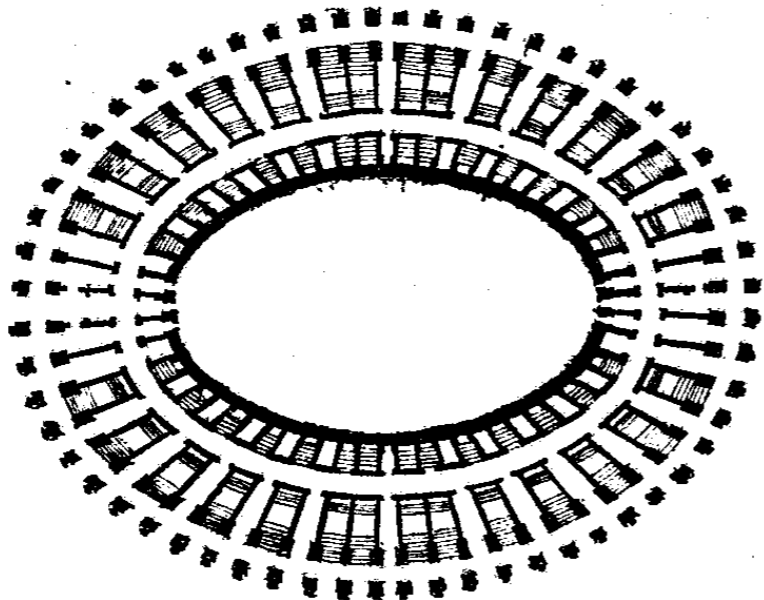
Amphithéâtre de Nîmes, plan du rez-de-chaussée.
